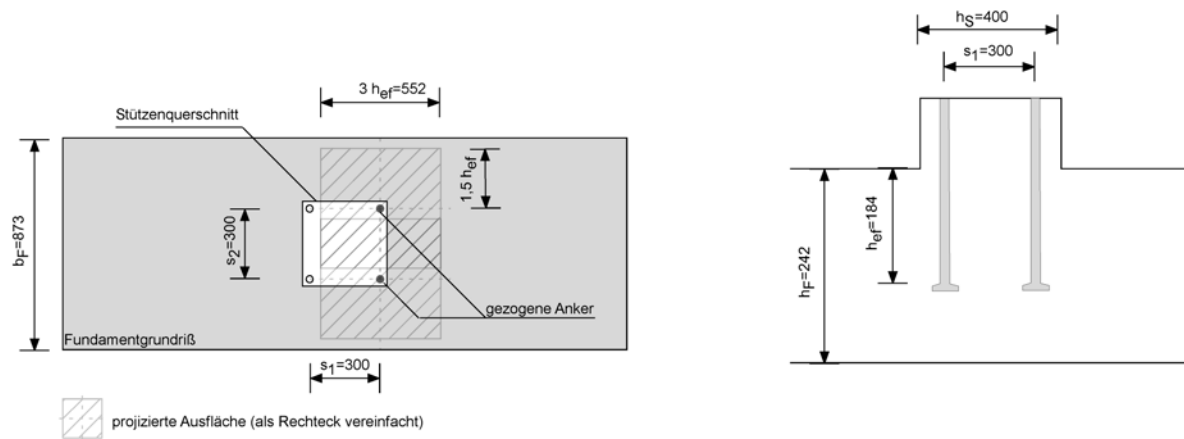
Ermittlung der projizierten Ausbruchflächen
